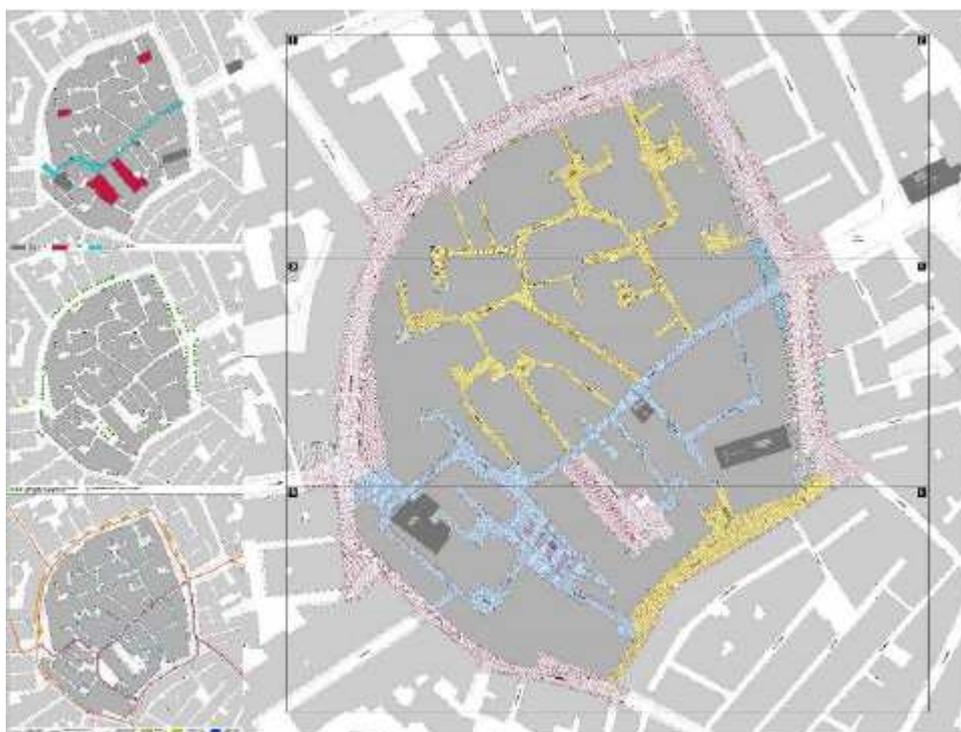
Progetto di riqualificazione del centro storico – Planimetria Generale
